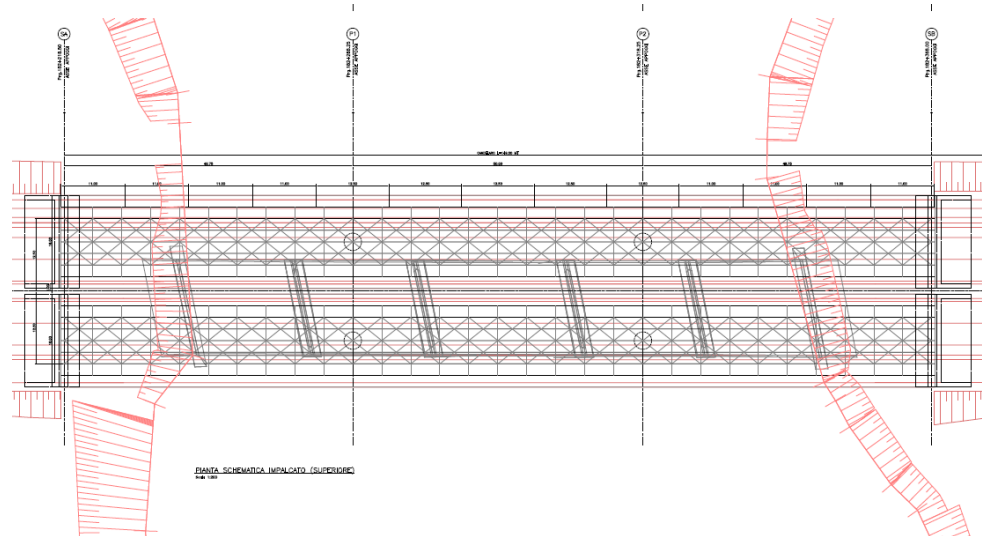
Prospetto dell'impalcato del viadotto di progetto
